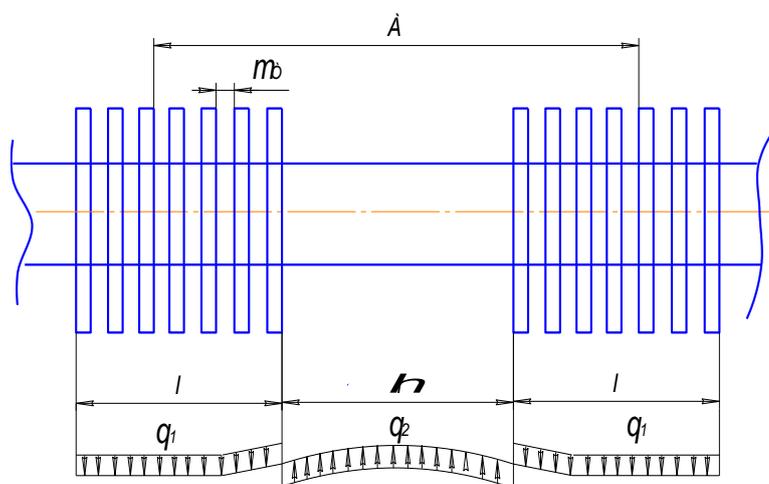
Расчетная схема при группой установке грузов на трубопровод
